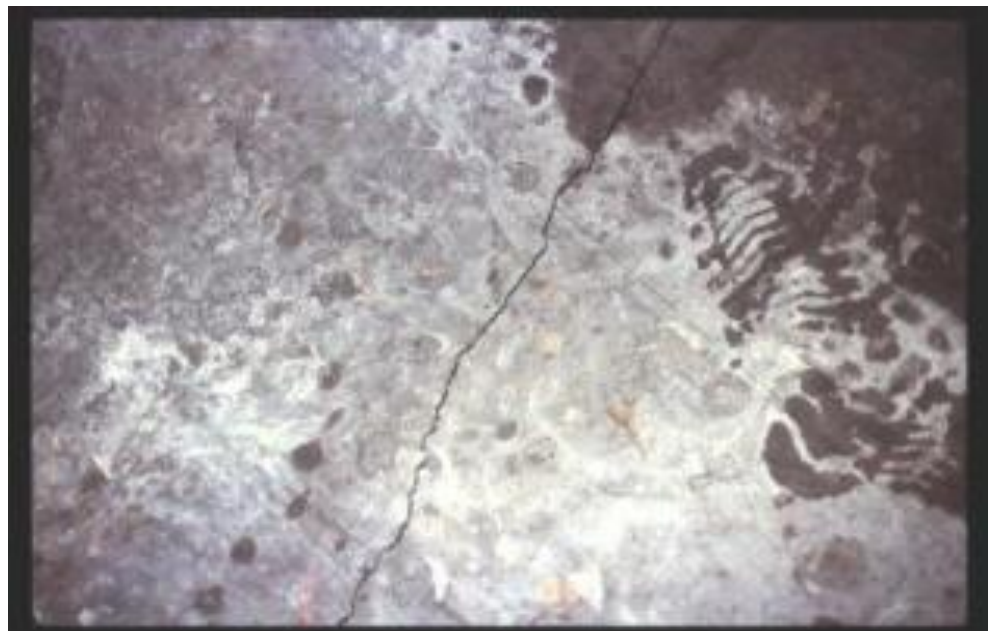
fissuration par retrait gêné d'une glissière en béton adhérent (GBA).
